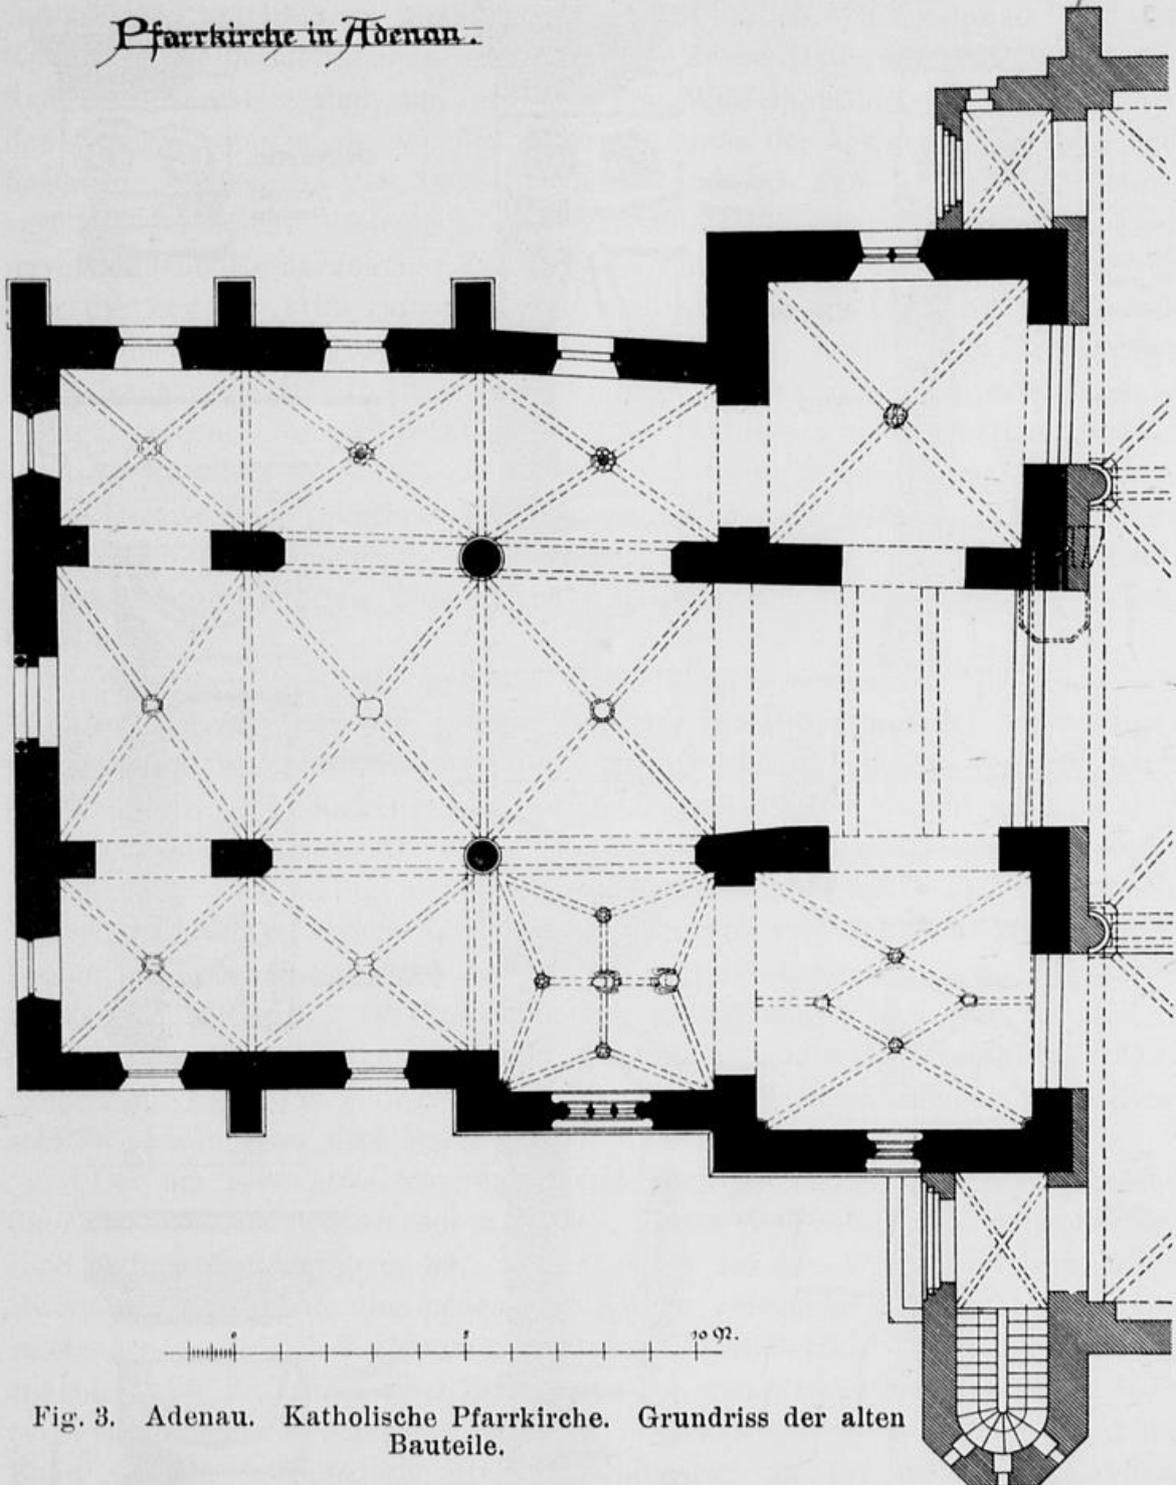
Adenau. Katholische Pfarrkirche. Grundriss der alten Bauteile.
